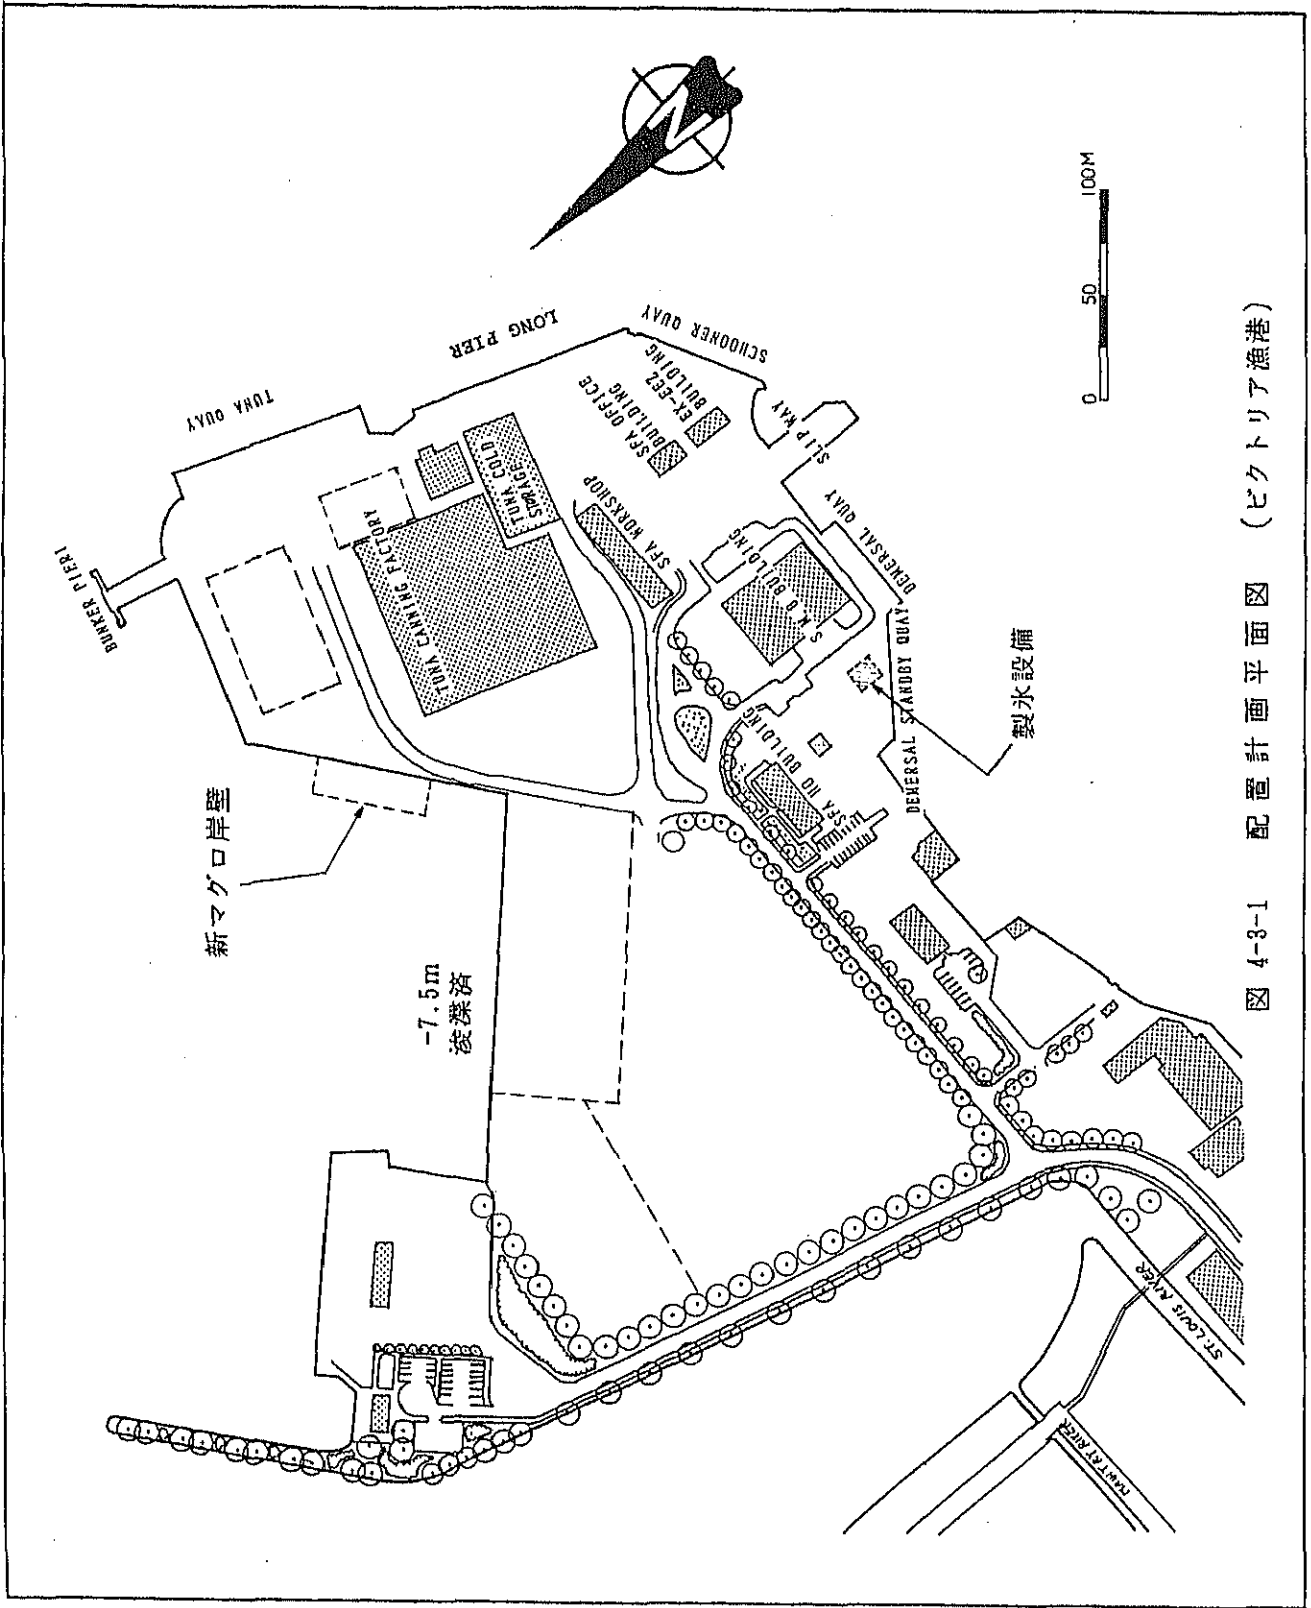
配置計画平面図 (ビクトリア漁港)
